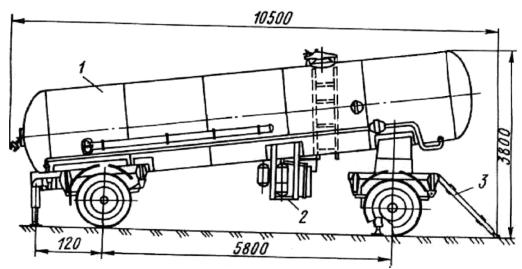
Передвижной склад цемента СБ-74А-1 (с электроприводом): I – цистерна; 2 – компрессорный агрегат; 3 – подкатная тележка
